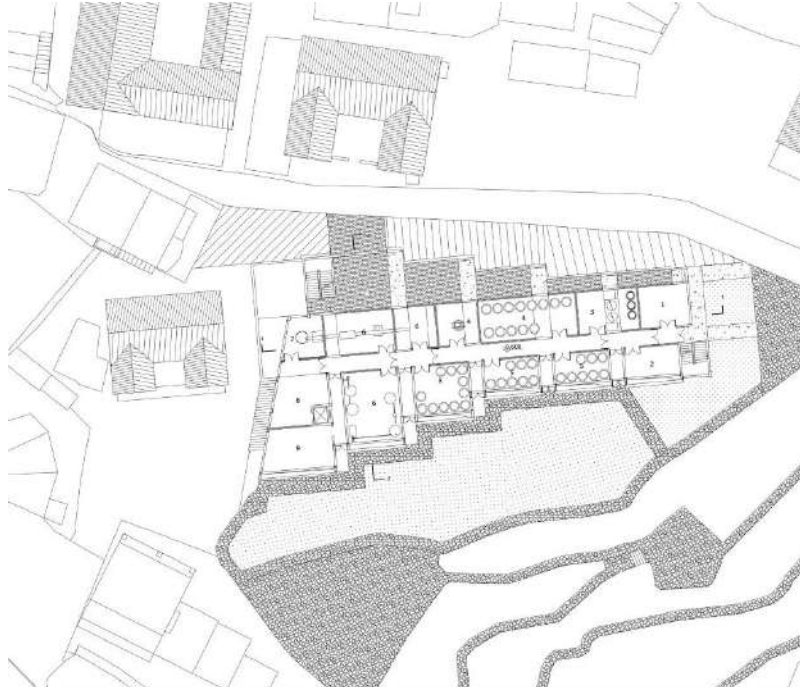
de fotoğrafı olan yapı, tarihi şarap mahzenlerinin formunu yansıtan siyah beton tonozlardan ve perfore tuğla duvarlardan inşa edilmiş bir fabrika yapısıdır. Şekil 35 de paylaşılan giriş kat planından okunduğu üzere, mimarının bölgede gerçekleştirdiği diğer işlerde olduğu gibi, bu üretim yapısında da, üretim mekanları boyunca devam eden ziyaret ve gözlem alanları, rotaları yaratılmıştır. Bu proje de, köyün girişinde bir lokasyonda konumlandırılmıştır. Bodrum kat şarap mahzenlerine ayrılmıştır. Zemin kat üretim mekanlarına ve ziyaretçilerin bu üretimi izleyebilecekleri mekanlara tahsis edilmiştir. Bir üst kat ise, yerli halkın ve dileyen herkesin sosyalleşmesine imkan verecek açık bir platform olarak düşünülmüştür.
